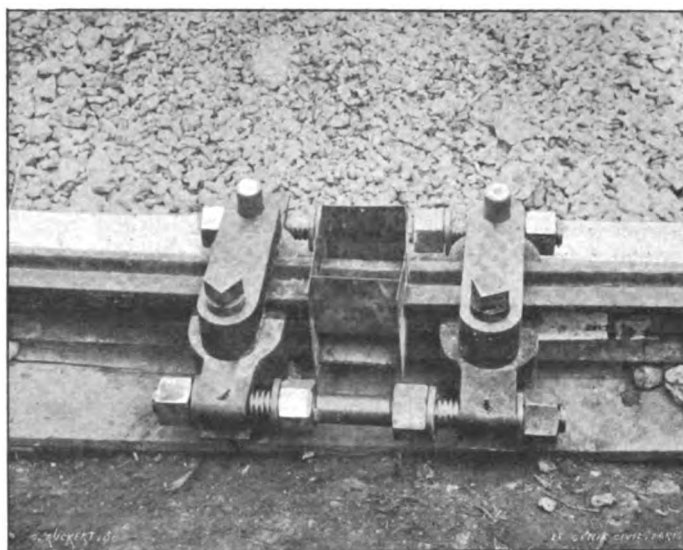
Vue montrant les rails à souder réunis par des tirants à vis et la ligne de soudure entourée d'un moule en tôle.
